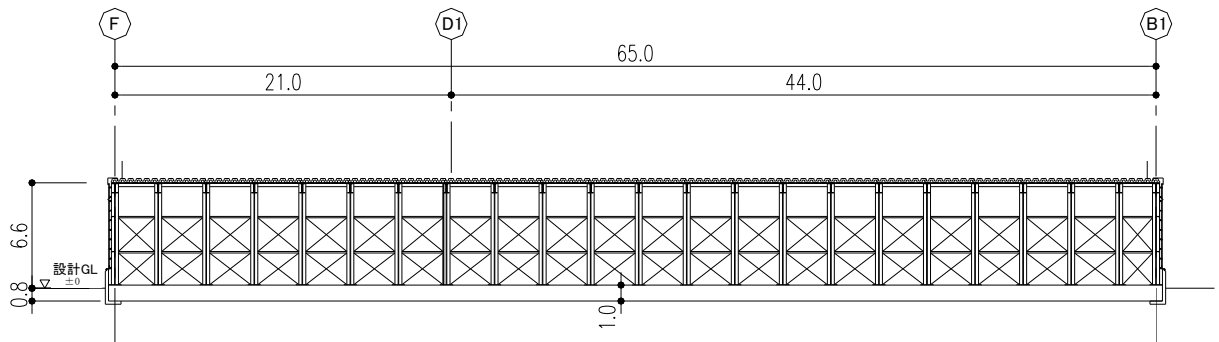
設備棟 B-B断面図 (EW方向) (単位:m)
